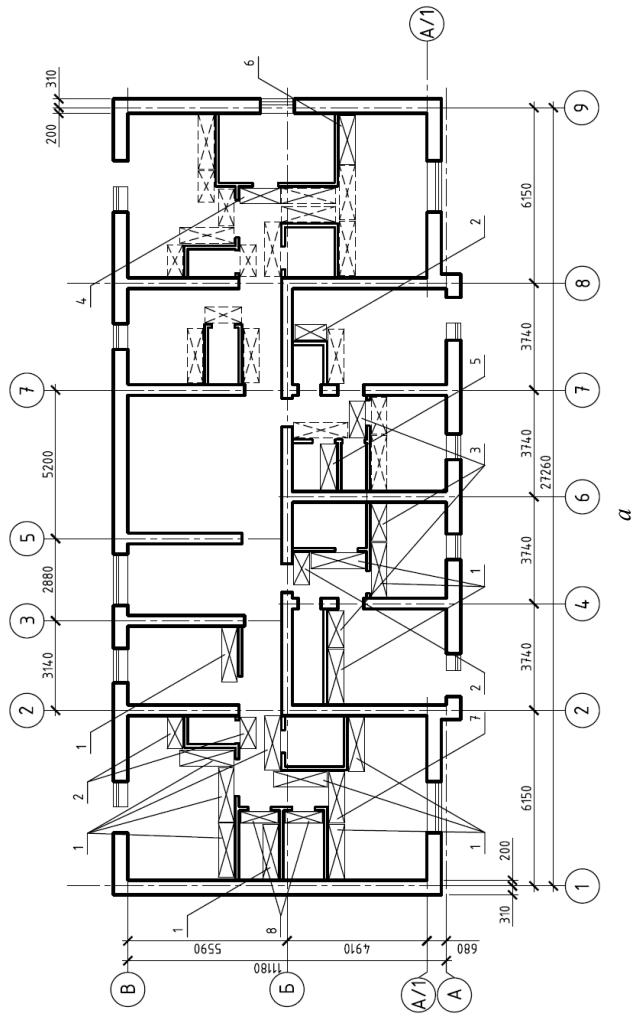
Схема расстановки подмостей при кладке перегородок после процесса монтажа плит перекрытия:
